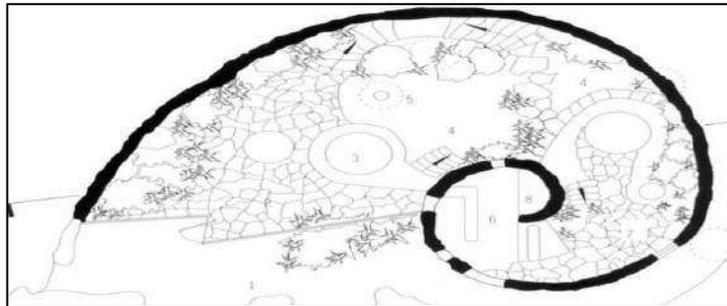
, que muestra un ejemplo de planta arquitectónica descargada de la web
